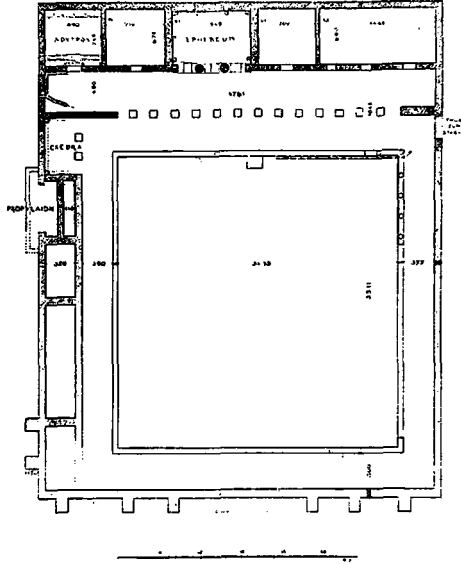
Grundriss des unteren Gymnasiums.
